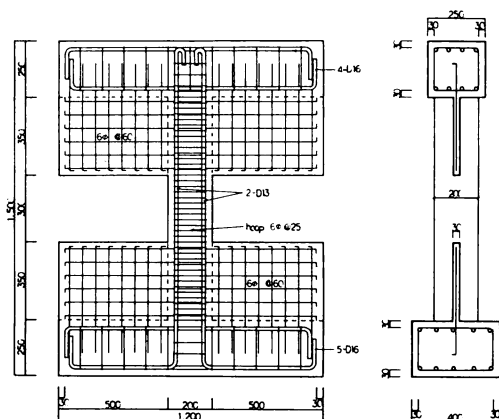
(b) 試験体 CSS02 の配筋図 (寸法単位mm)
